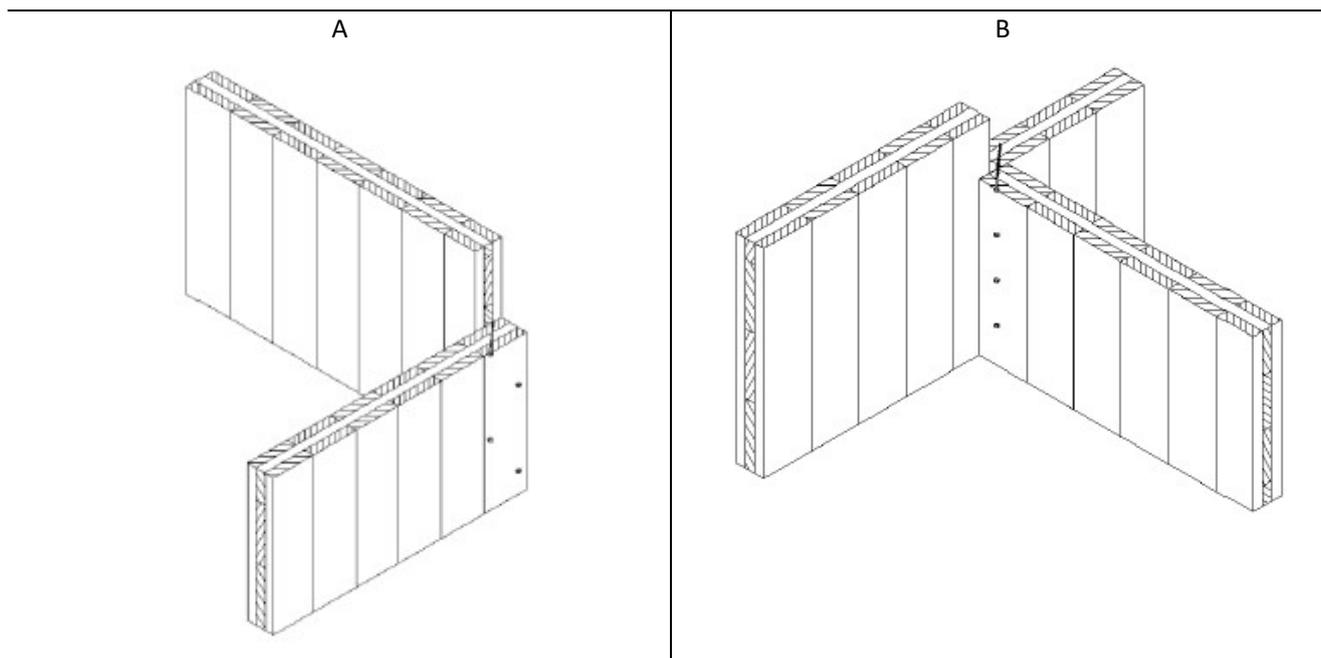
Collegamento d'angolo tra pareti con viti incrociate. A per pareti d'angolo. B giunto con pareti interne
